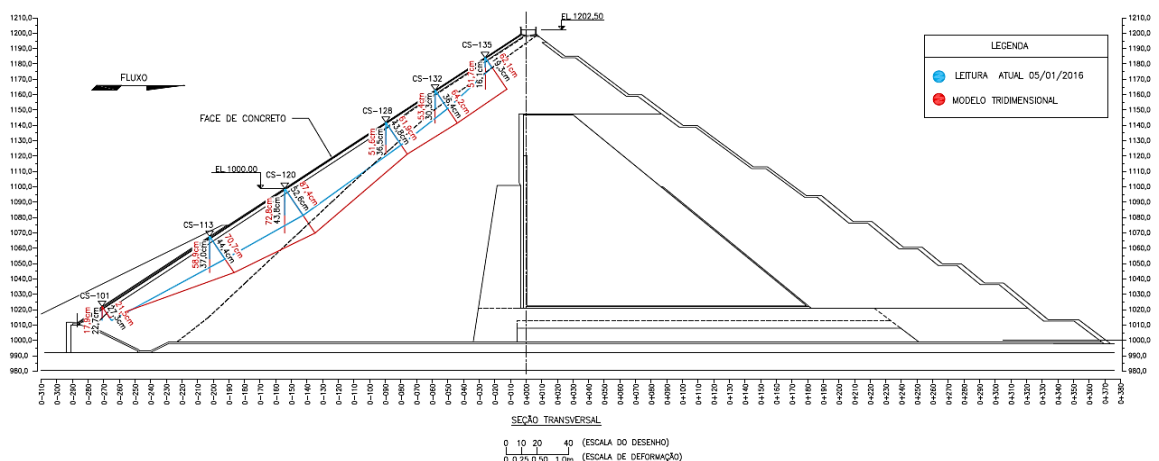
Seção Transversal – Deformação da Face de Concreto
